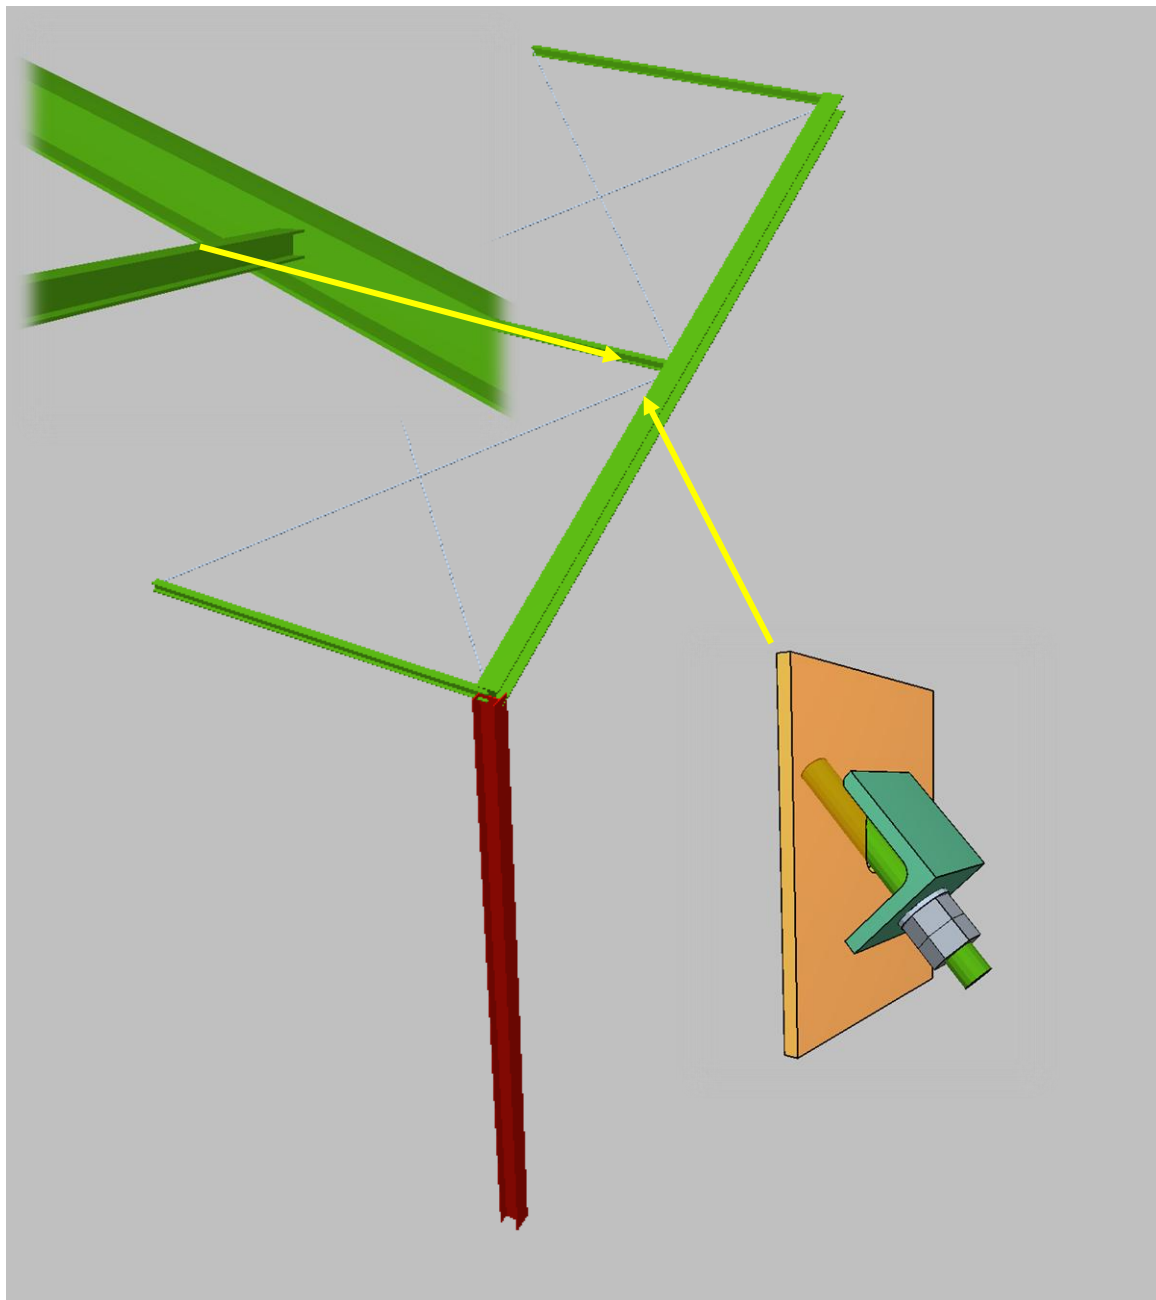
Unión de barras de arriostriamiento y tirantes con vigas de cubierta.
